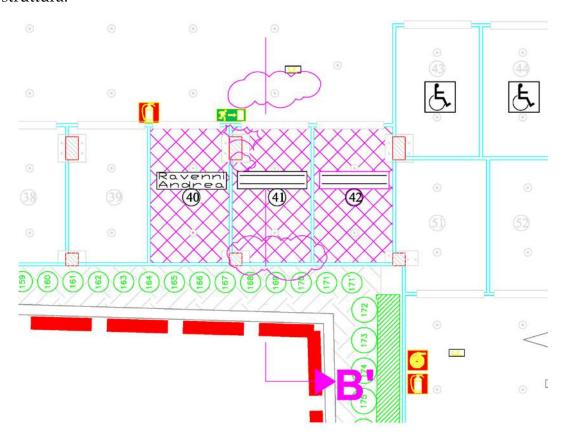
Stralcio Planimetrico Autorimessa 3 Box 41
